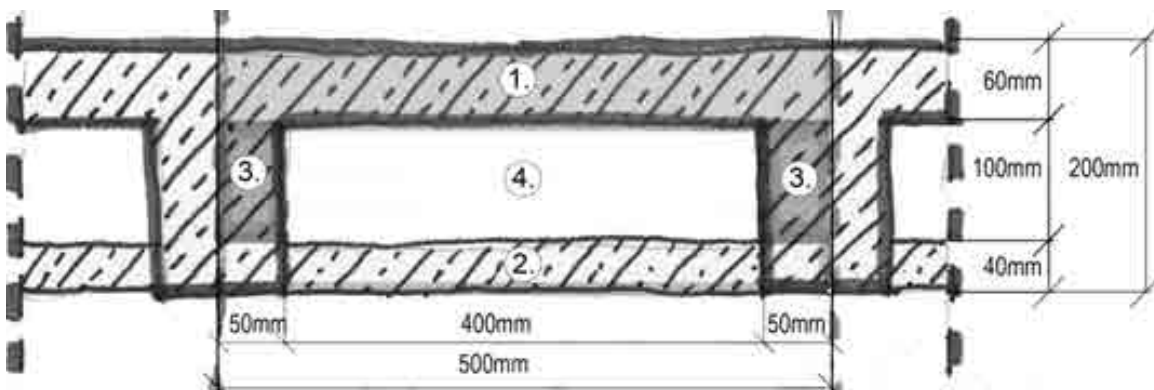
Probenabschnitt Hohlraumdecke Bestand\_20cm\_6cm
